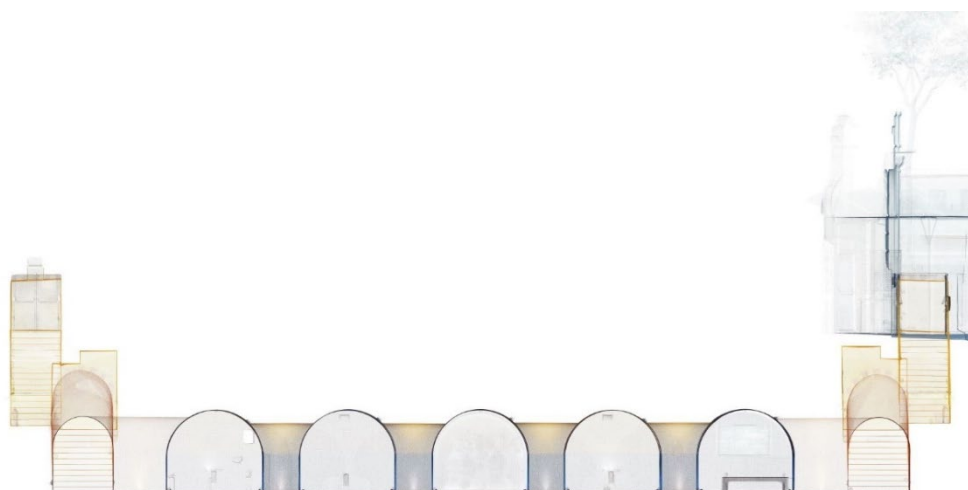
Ortoimagen del refugio por la sección longitudinal mayor
